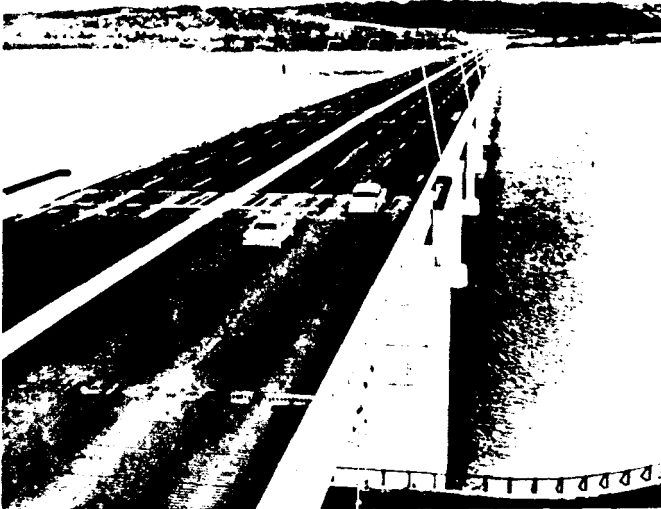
Calzada pavimentada con asfalto en el puente nuevo de Woodrow Wilson, Washington.
